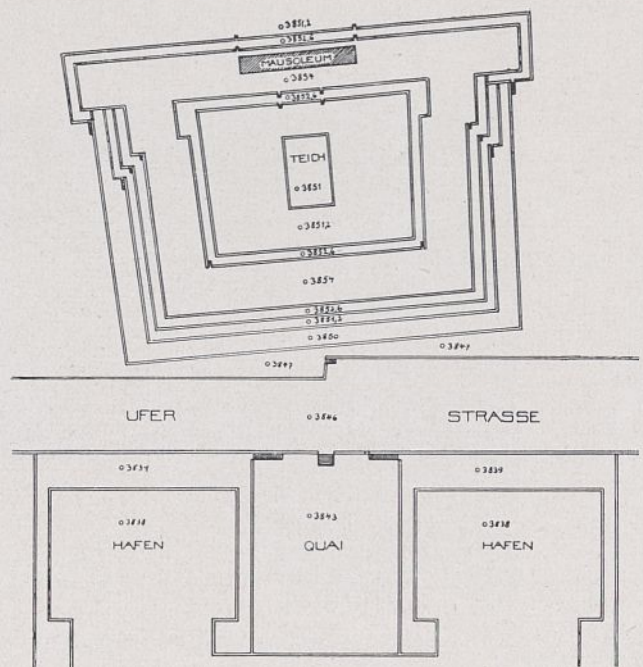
Lageplan der Rekonstruktion. M. 1 : 5000.
